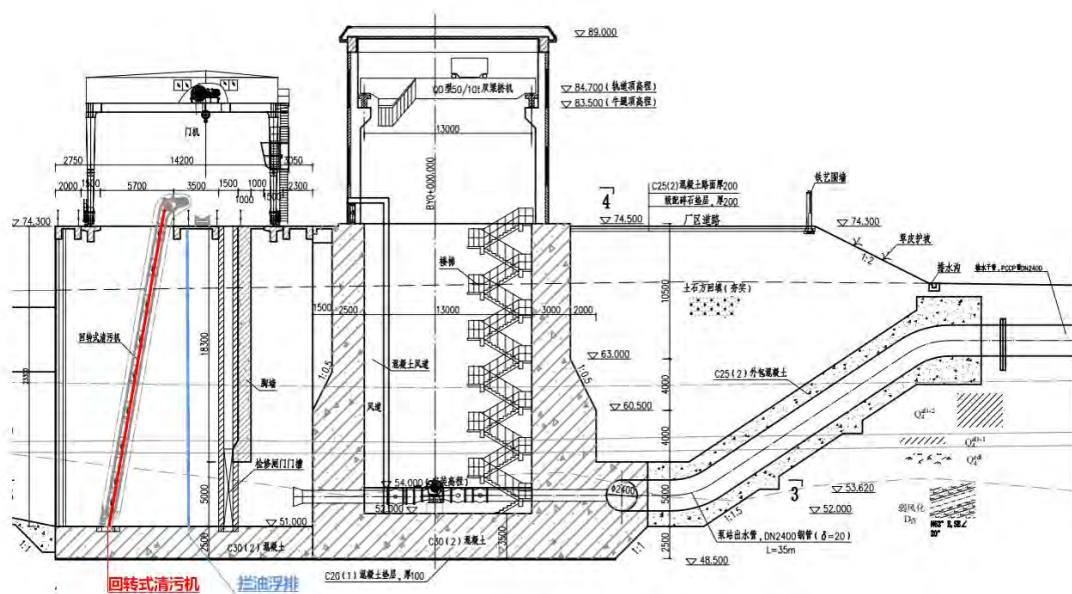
田里泵站取水口清污机、拦油浮排布置图
